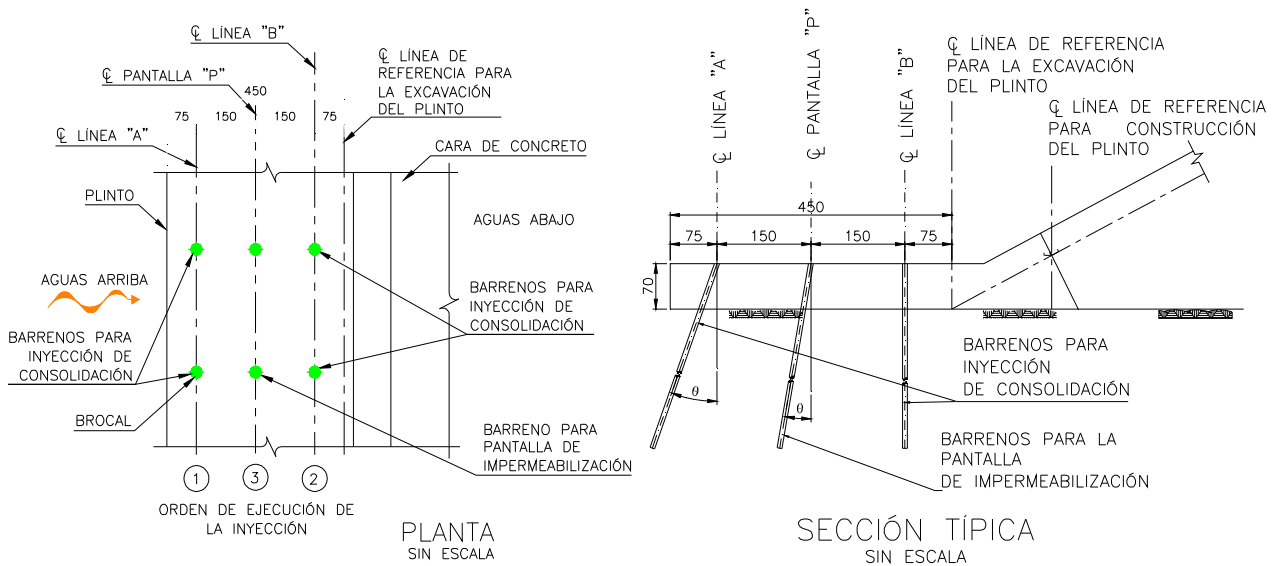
Planta y sección del Plinto y distribución de los barrenos de inyección en el tramo P7-P8.
